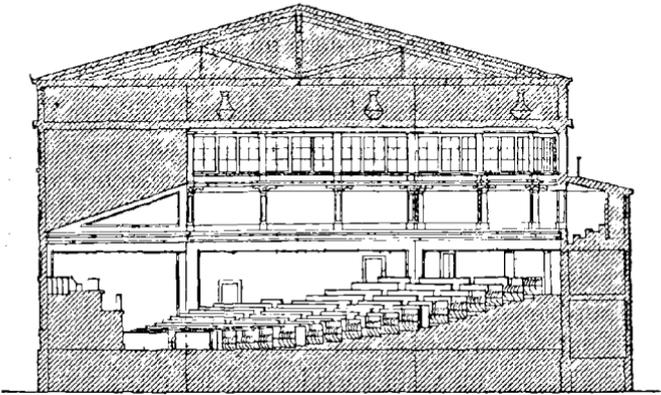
Coupe parallèle a la ligne C D du plan.
